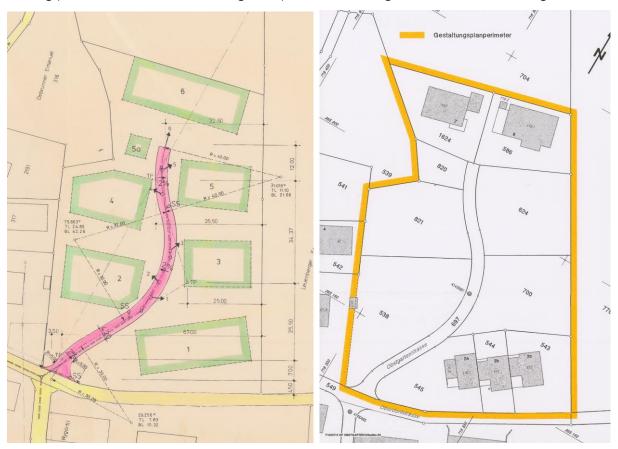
Gestaltungsplan 1988 (aufgehoben) und Gestaltungsplan 2004
